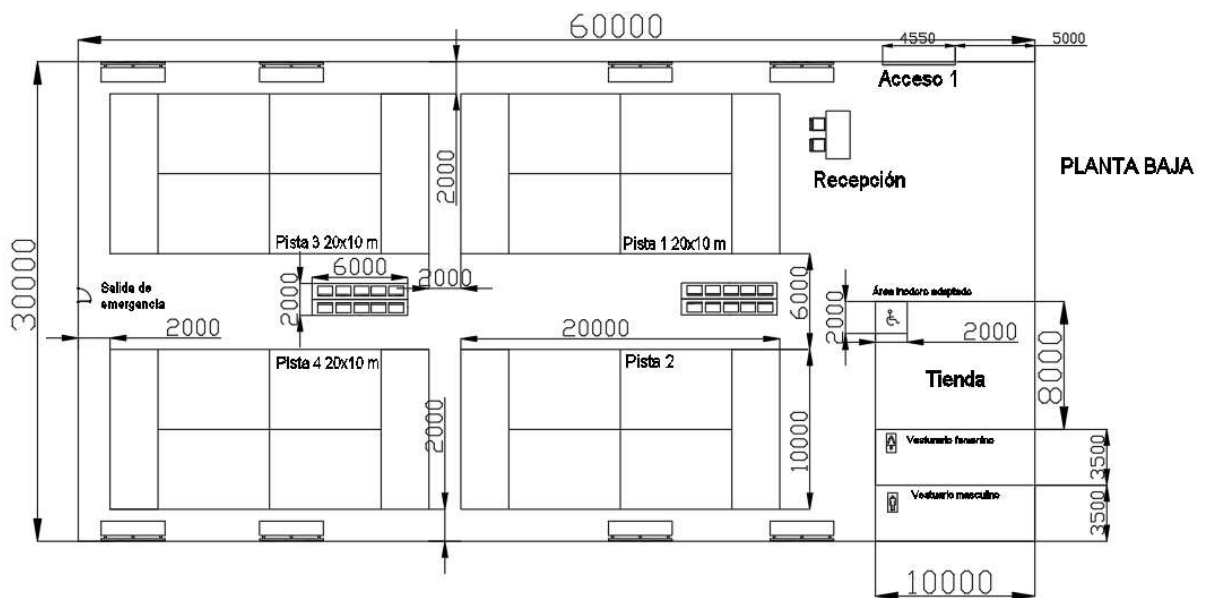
Distribución en planta baja (cotas en mm).
